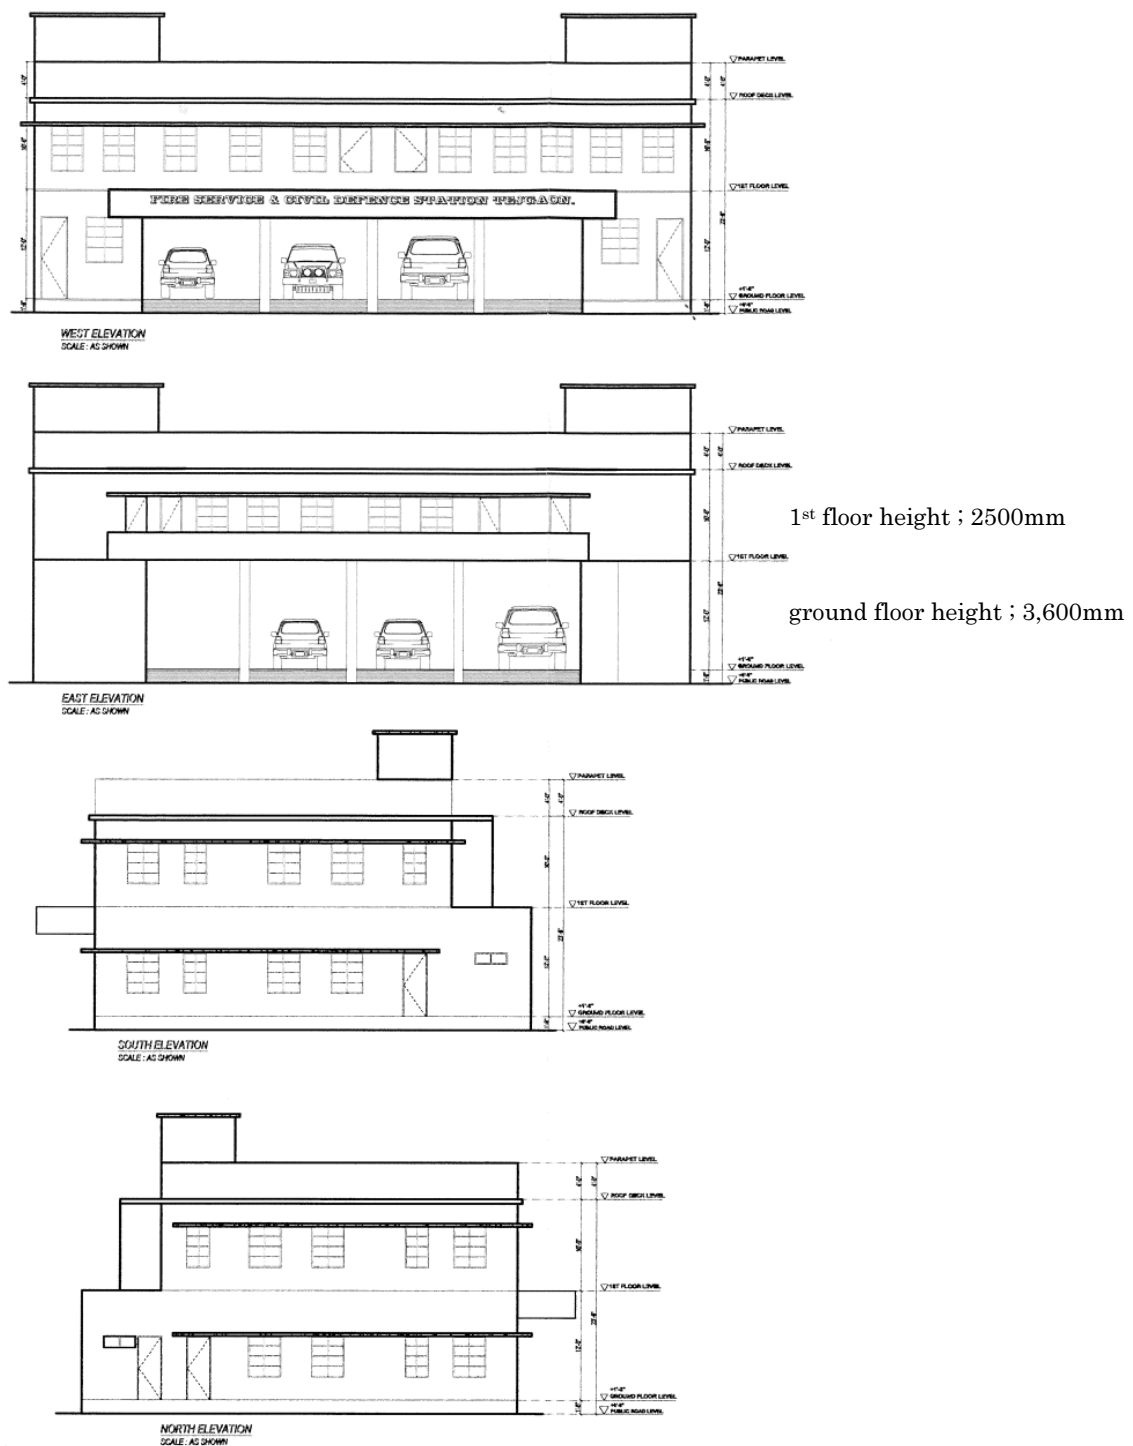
建物立面図（階高は地上階 3,600mm、1 階は 2,600mm）
